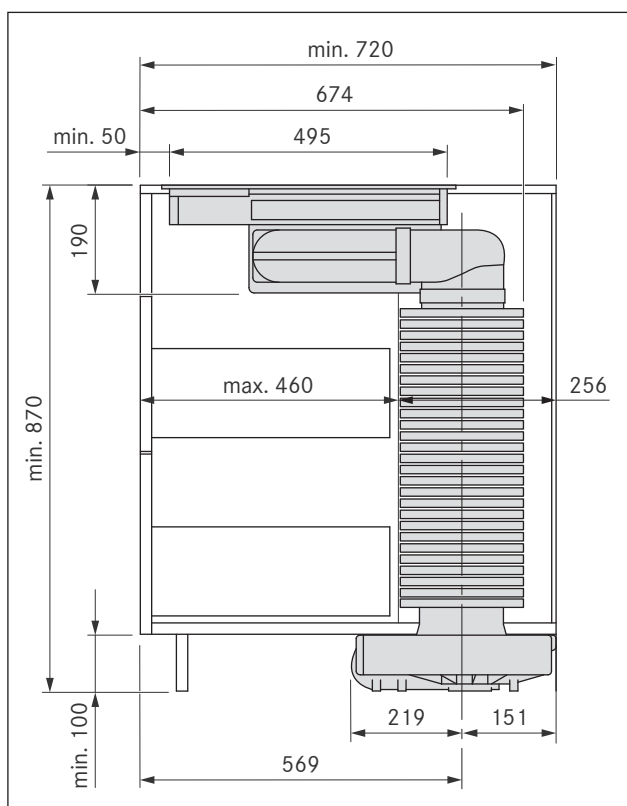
Dimensões de montagem do aparelho com silenciador redondo USDR50
